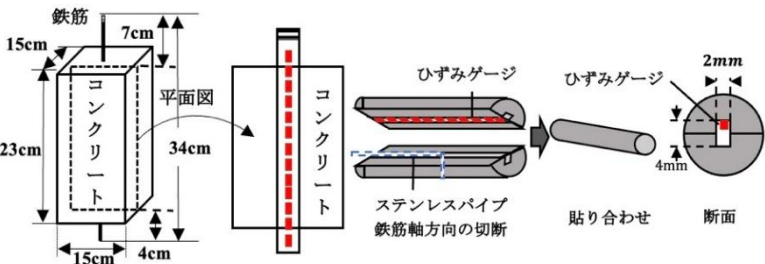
試験体概要 図-2 貼り合わせ鉄筋概
